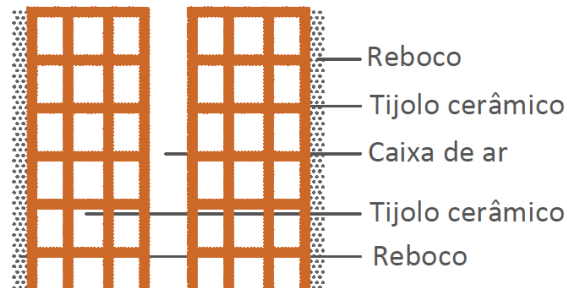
Solução construtiva tipo de parede para edifícios adjacentes – Pós intervenção
